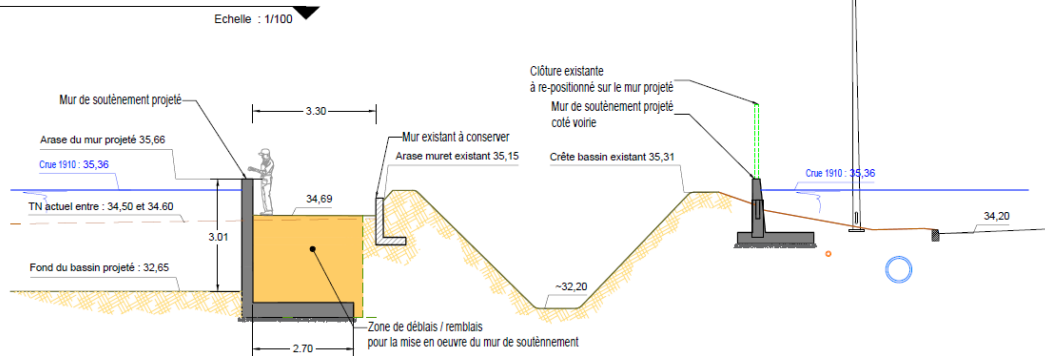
Plan et coupe du mur de clôture du bassin de compensation
